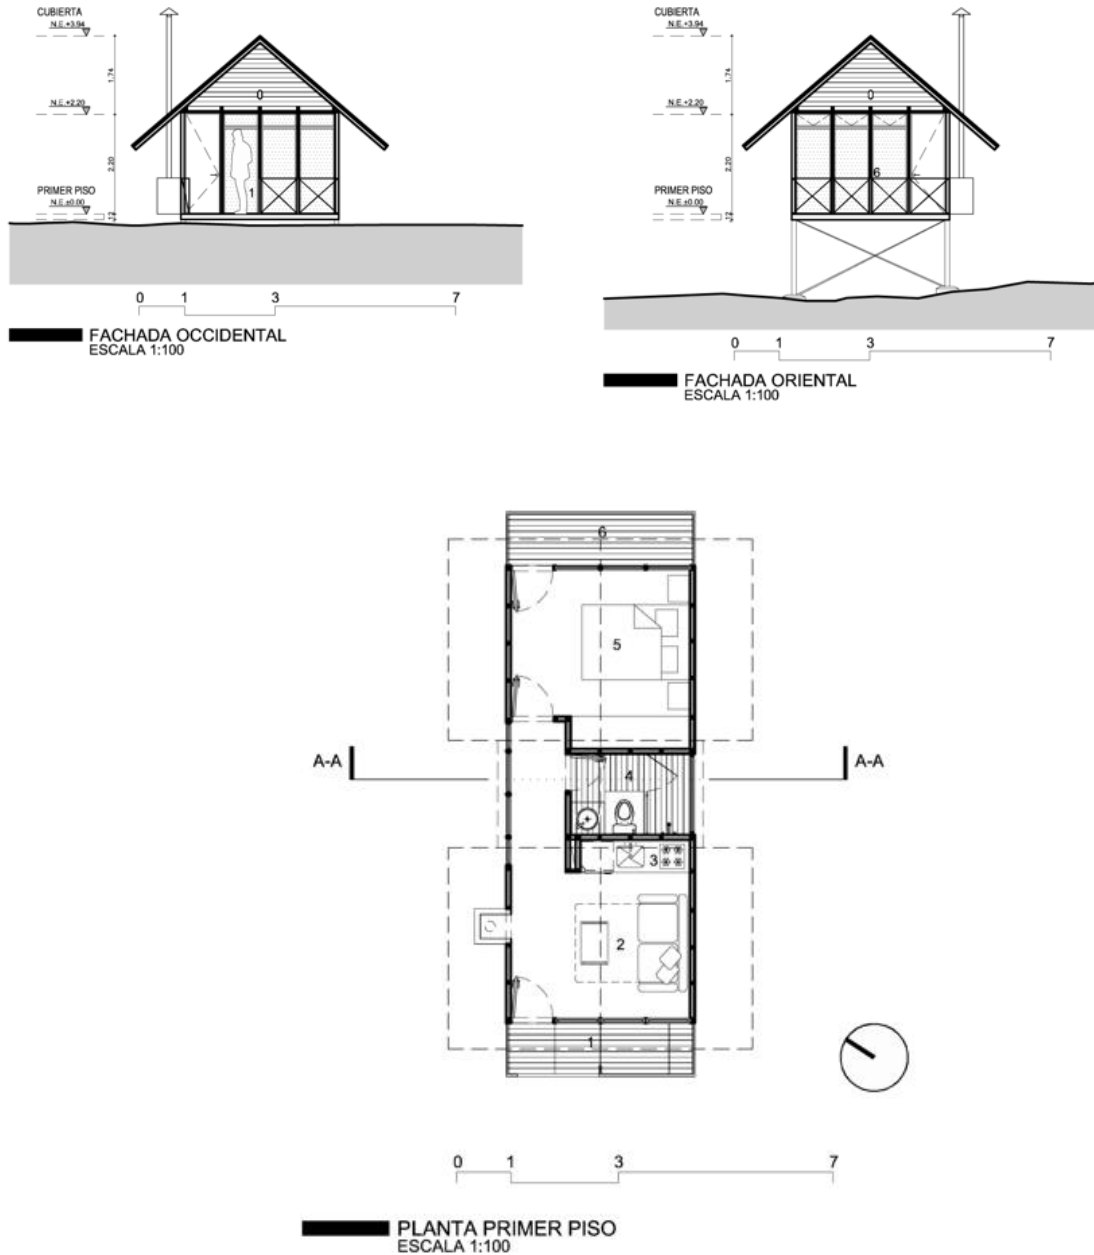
Proyecto Plano, Fuente Camacho Estudio Arquitectura
